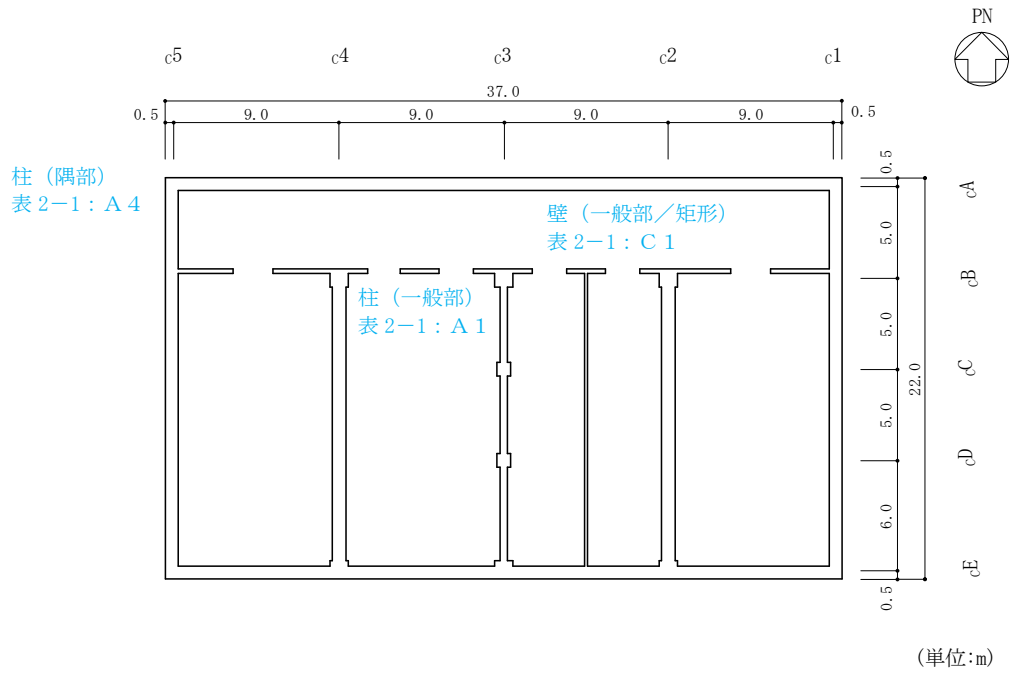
(1) 制御室建物の概略平面図 (EL 1.6m)
